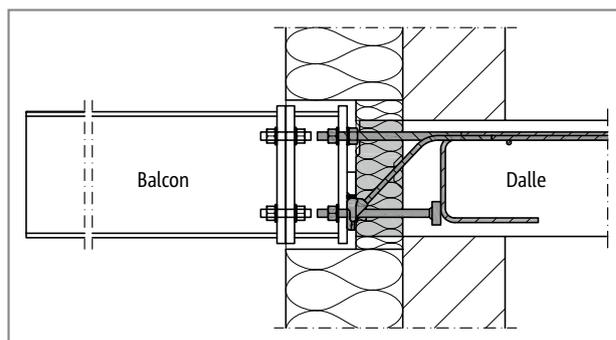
Schöck Isokorb® T type SK : Raccordement de la poutre en acier à un adaptateur compensant l'épaisseur de l'isolation externe
